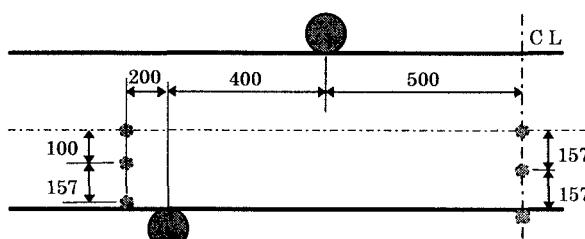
AEセンサ配置図 (曲げせん断破壊時) (mm)
